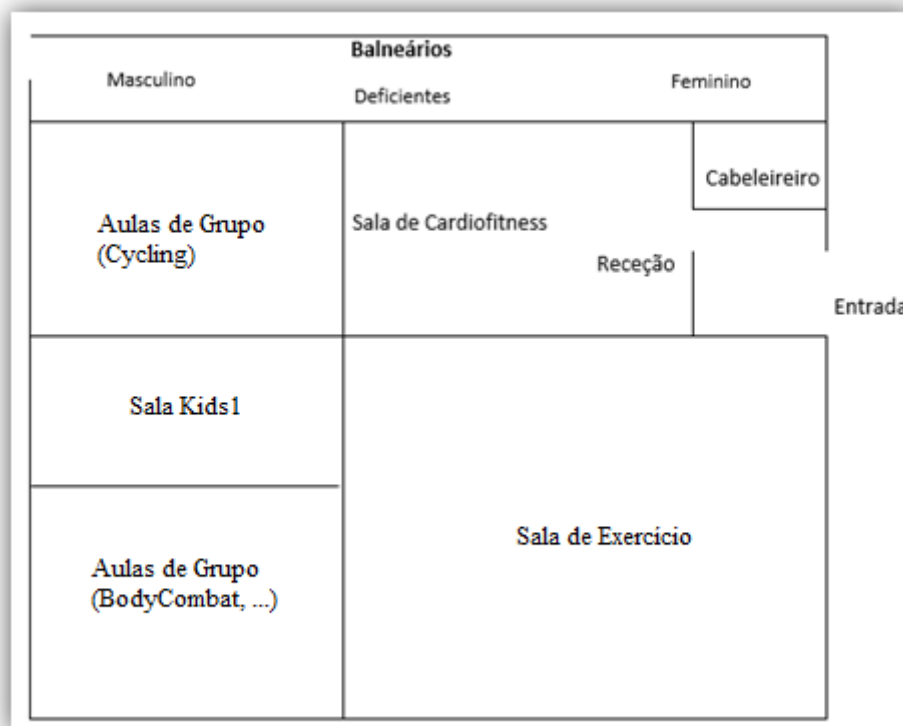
Planta do Ginásio (Fonte: Sofia Pinto)
